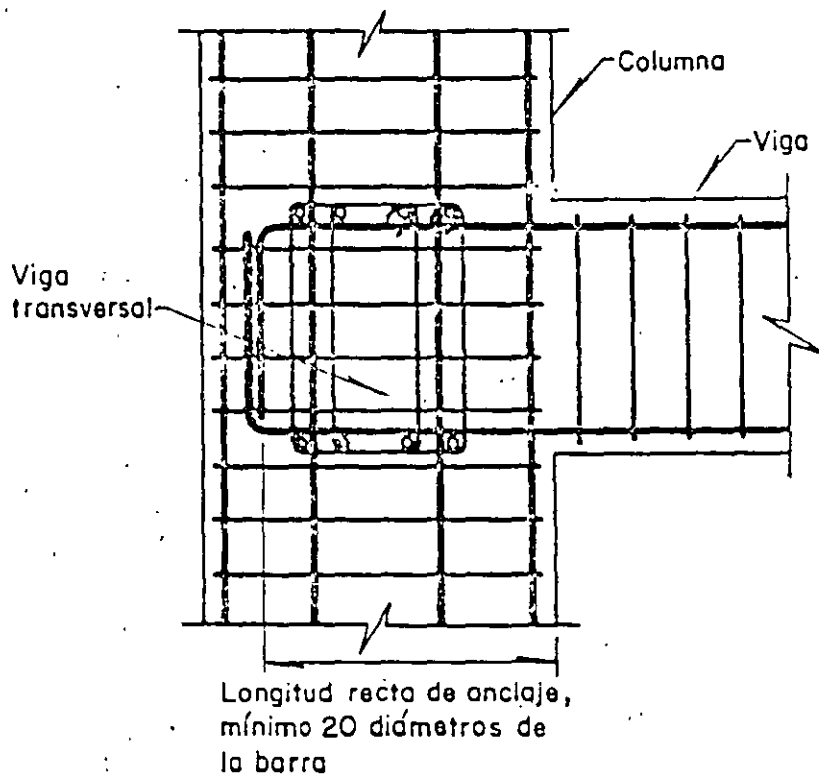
Ejemplo de unión viga-columna extrema según NTC del RDF87
